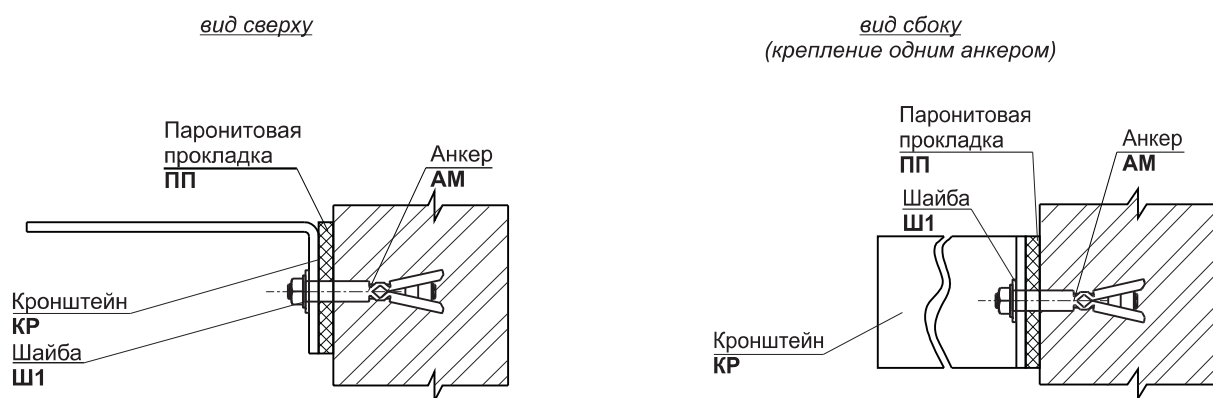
Узел крепления кронштейна КР к стене.
